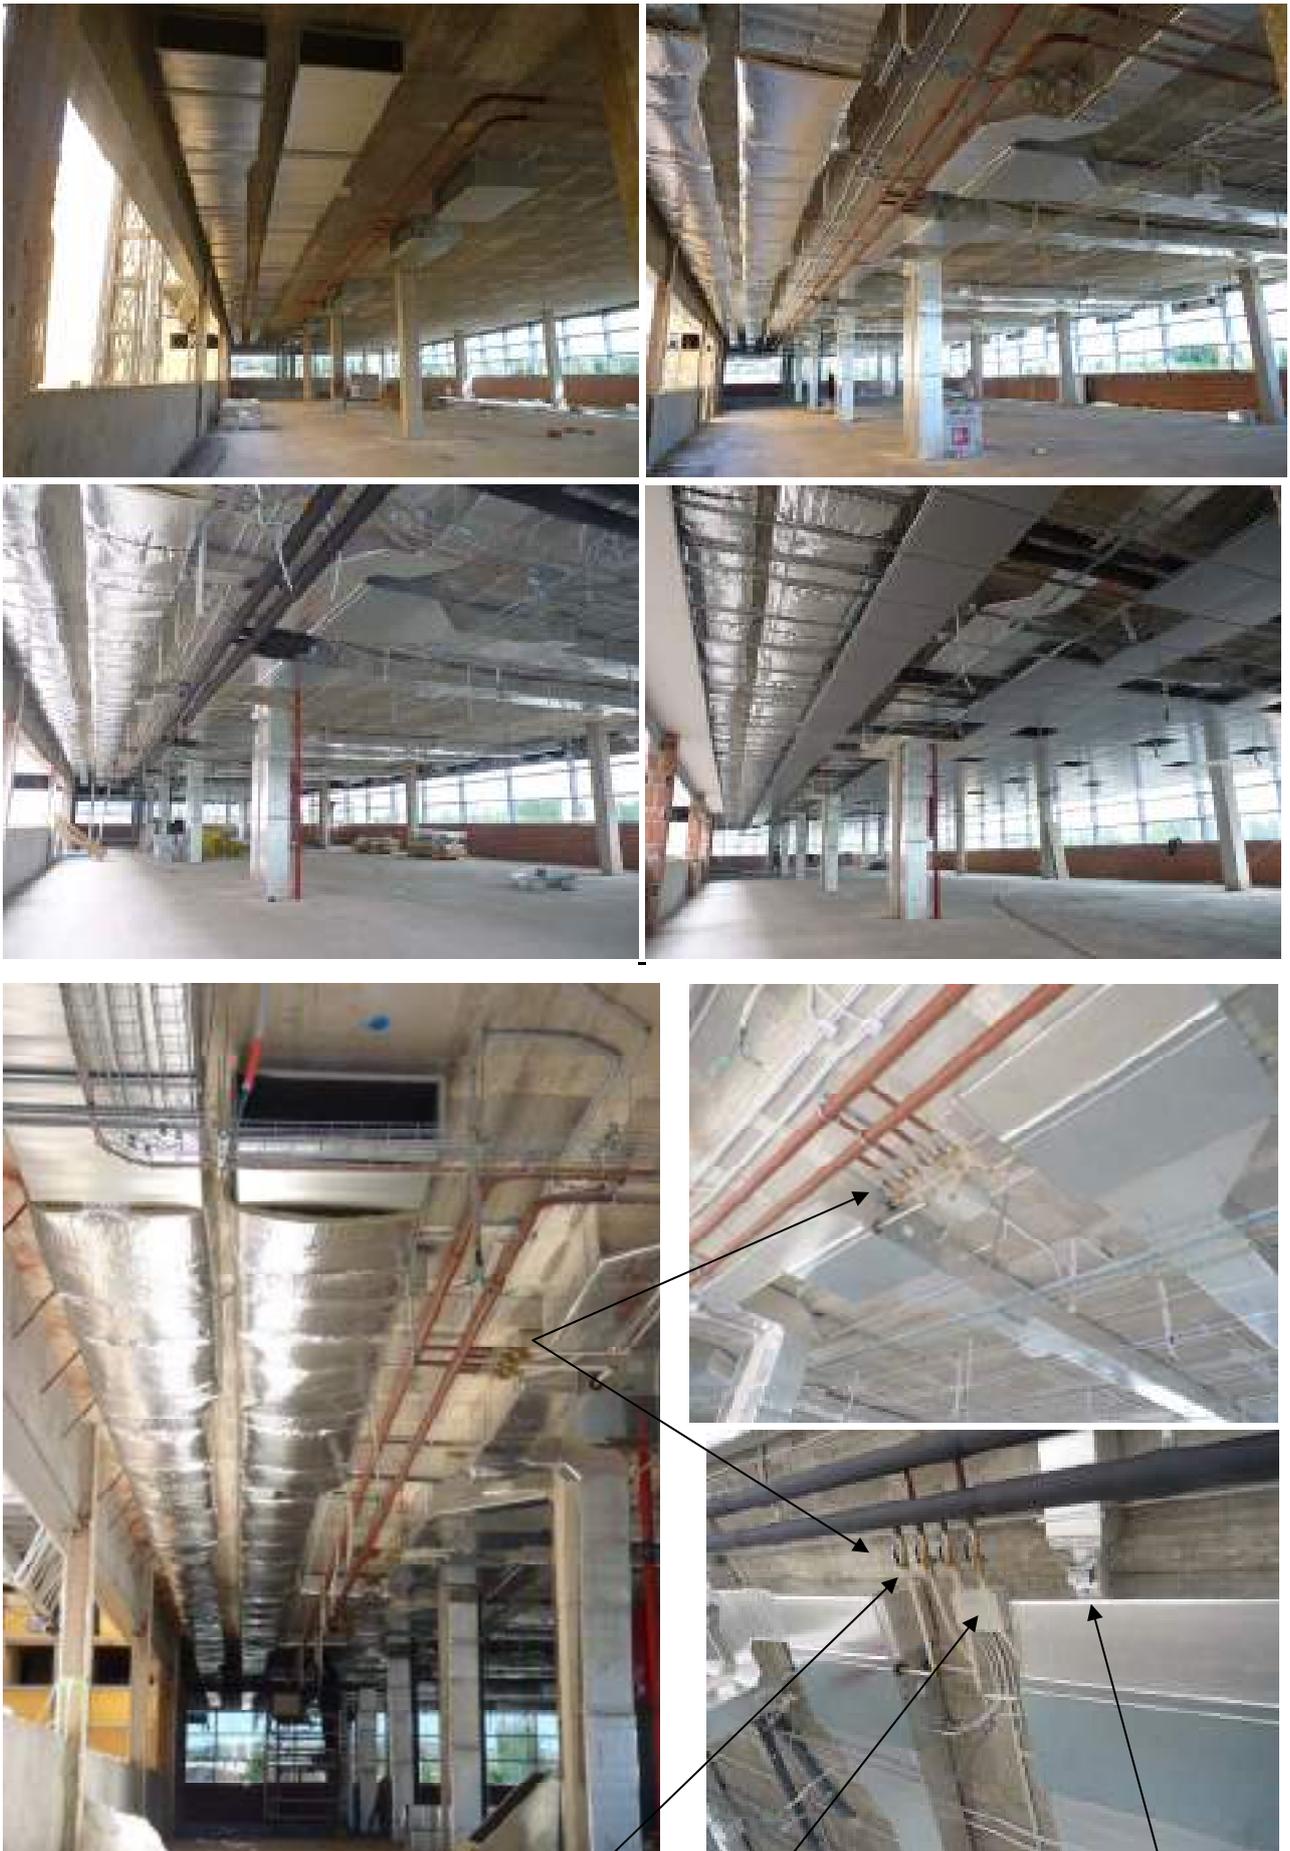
Interior de conductos de ventilación (Aislados) y extracción Garaje (sin aislar)
